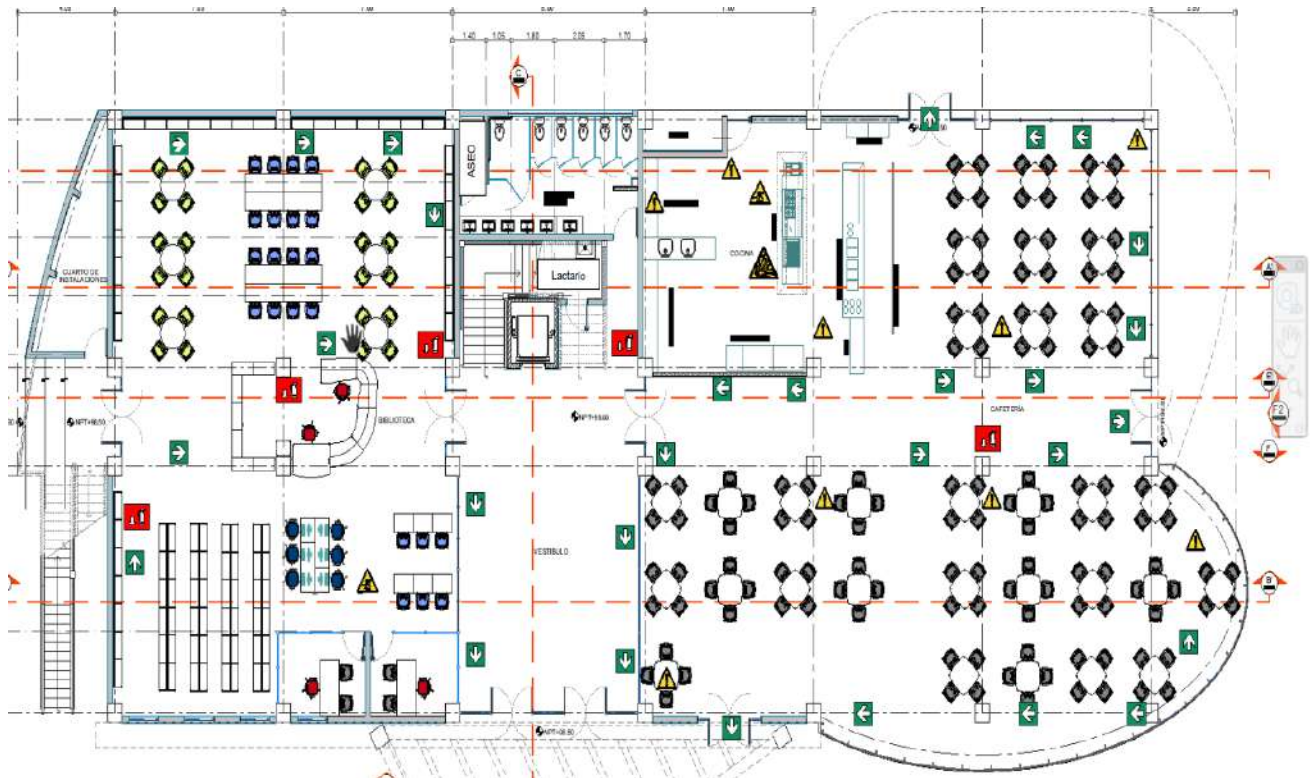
Plano edificio vertical planta baja, Fuente (Canchola & Vela, 2023)
